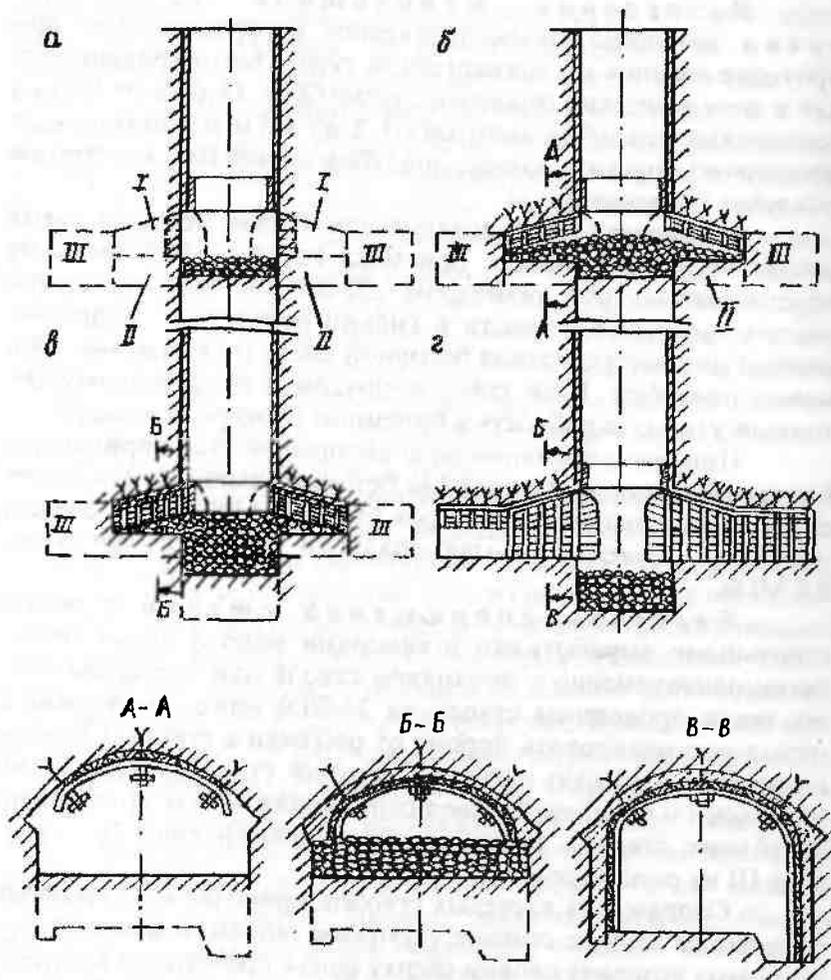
Рассечка сопряжения клетчатого ствола слоями I-III сверху вниз: а - положение до начала разработки верхнего (I) слоя; б - бетонирование свода верхнего слоя; в - углубка ствола перед разработкой нижнего (II) слоя; г - возведение постоянной бетонной крепи
